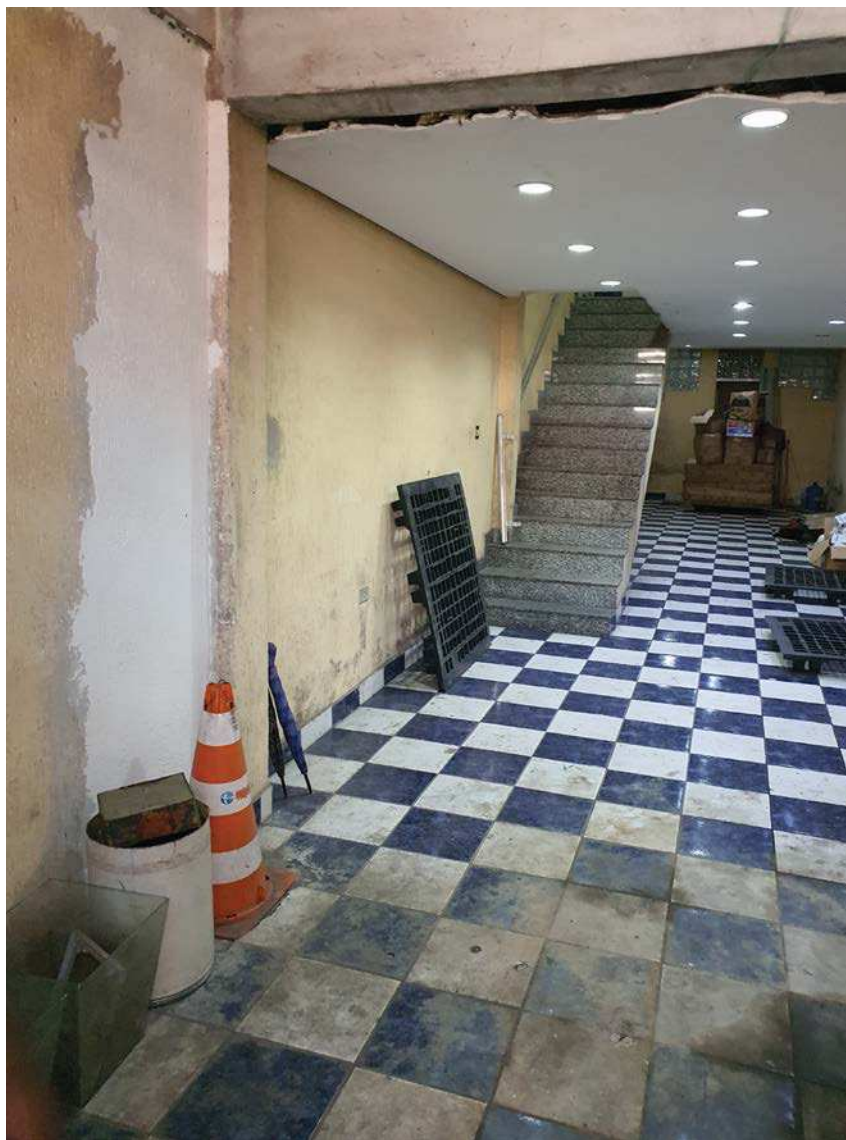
DIVISA LATERAL ESQUERDA INTERNA DO SALÃO.
